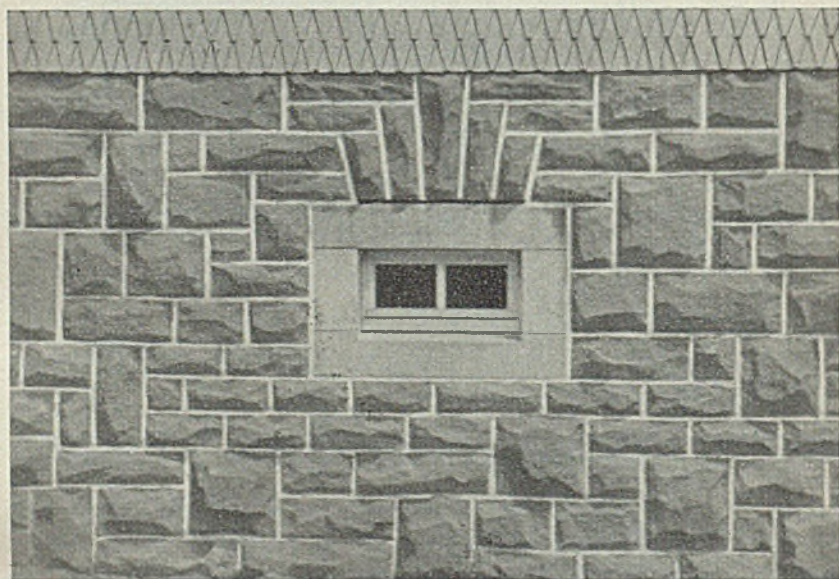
Haussockel aus Bruchsteinmauerwerk mit einer Fensterverblendung aus Werksteinen.
